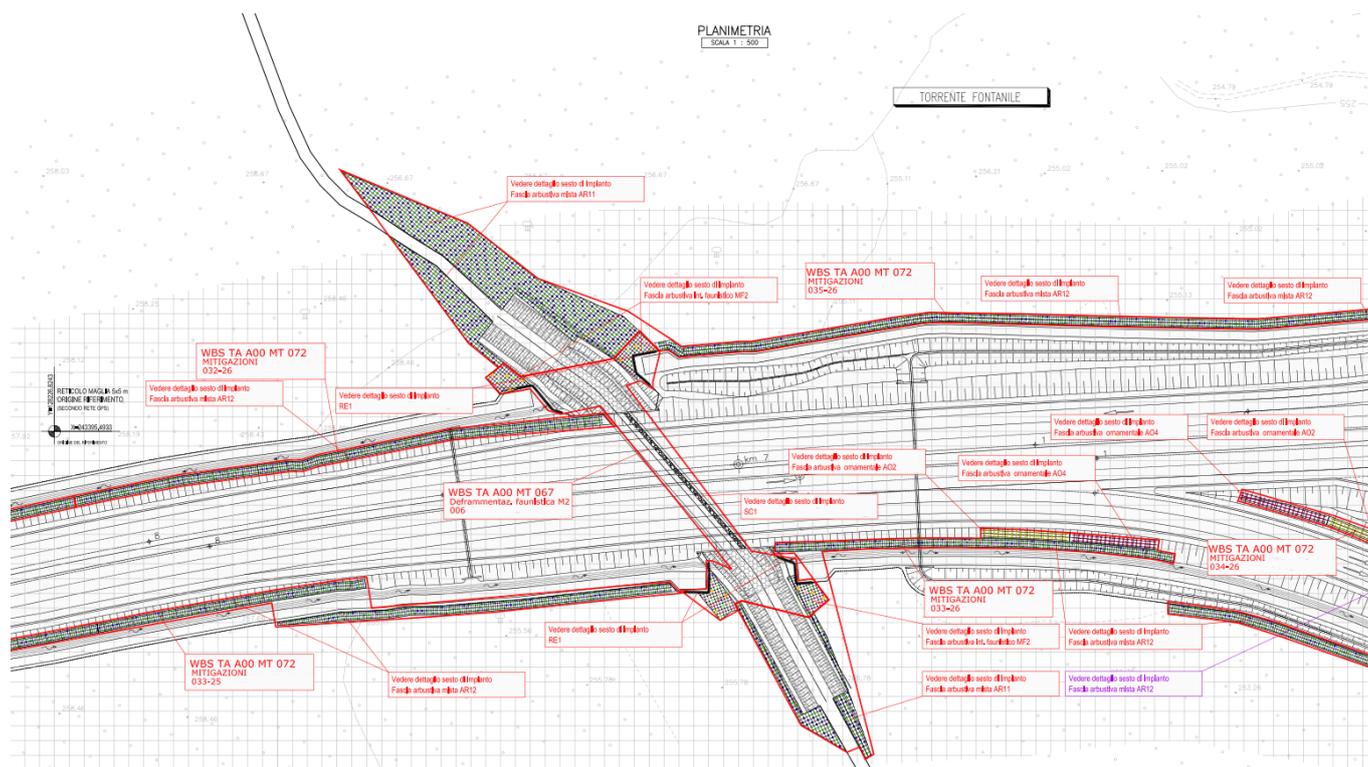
planimetria as built delle mitigazioni a verde nell’area del torrente Fontanile
